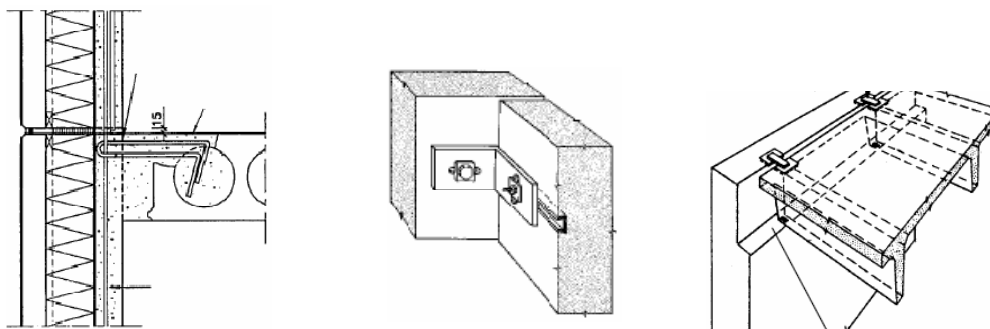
Exemplos de fixações de painéis (da esquerda para a direita): ligações por sobreposição de armadura, parafusadas e soldadas
